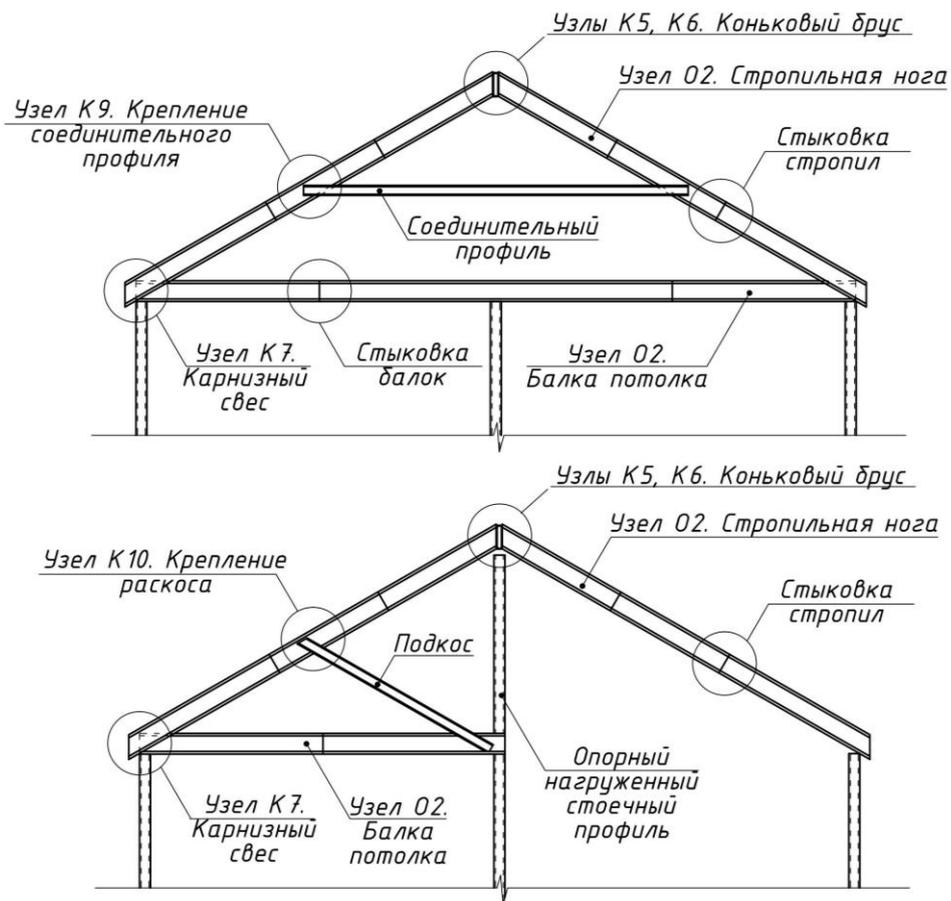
Узел К 2. Узлы стропильной конструкции крыши
